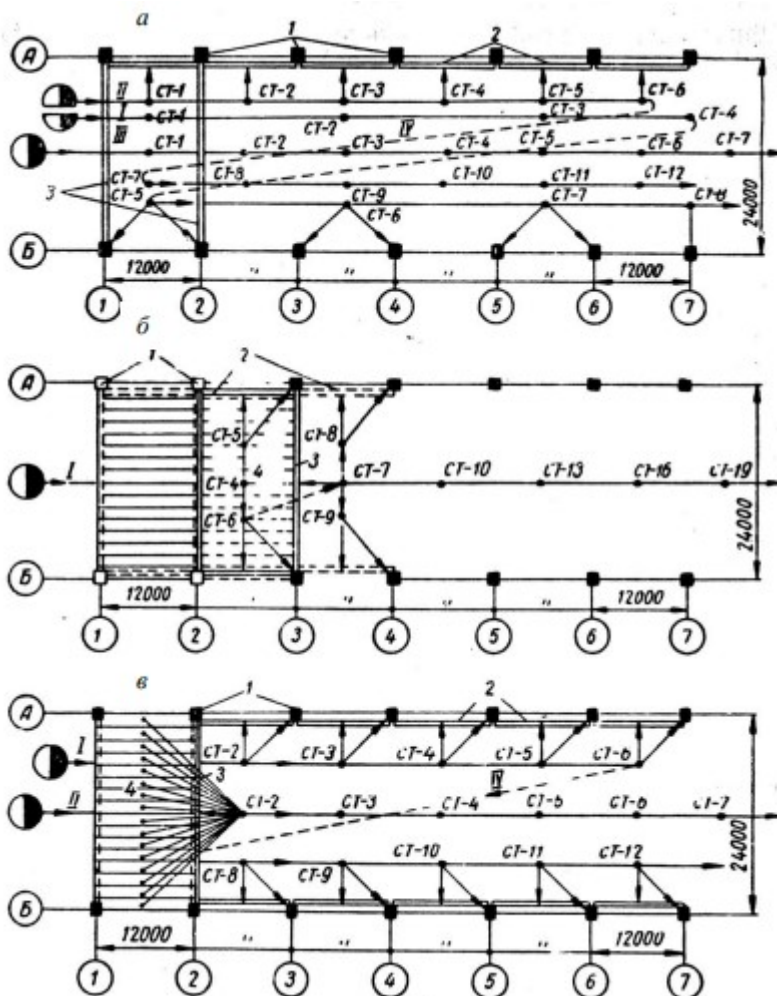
Схемы расстановки стреловых кранов: а – при отдельном методе монтажа, б – при комплексном методе, в – при комбинированном методе, 1 - колонны, 2 – подкрановые балки, 3 – стропильные фермы, 4 – плиты покрытия, I, II, III – проходы крана, IV – холостой ход, СТ – места стоянок крана
